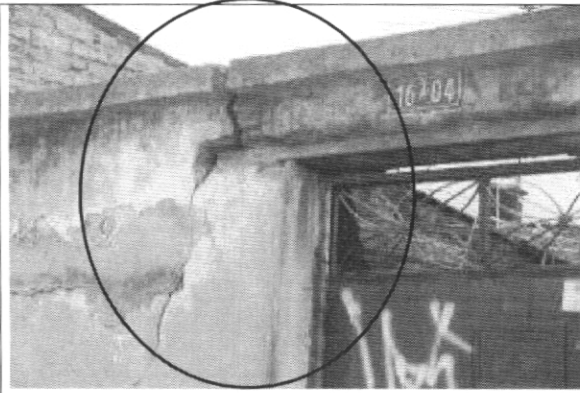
Grieta en muro de cerramiento costado occidental
